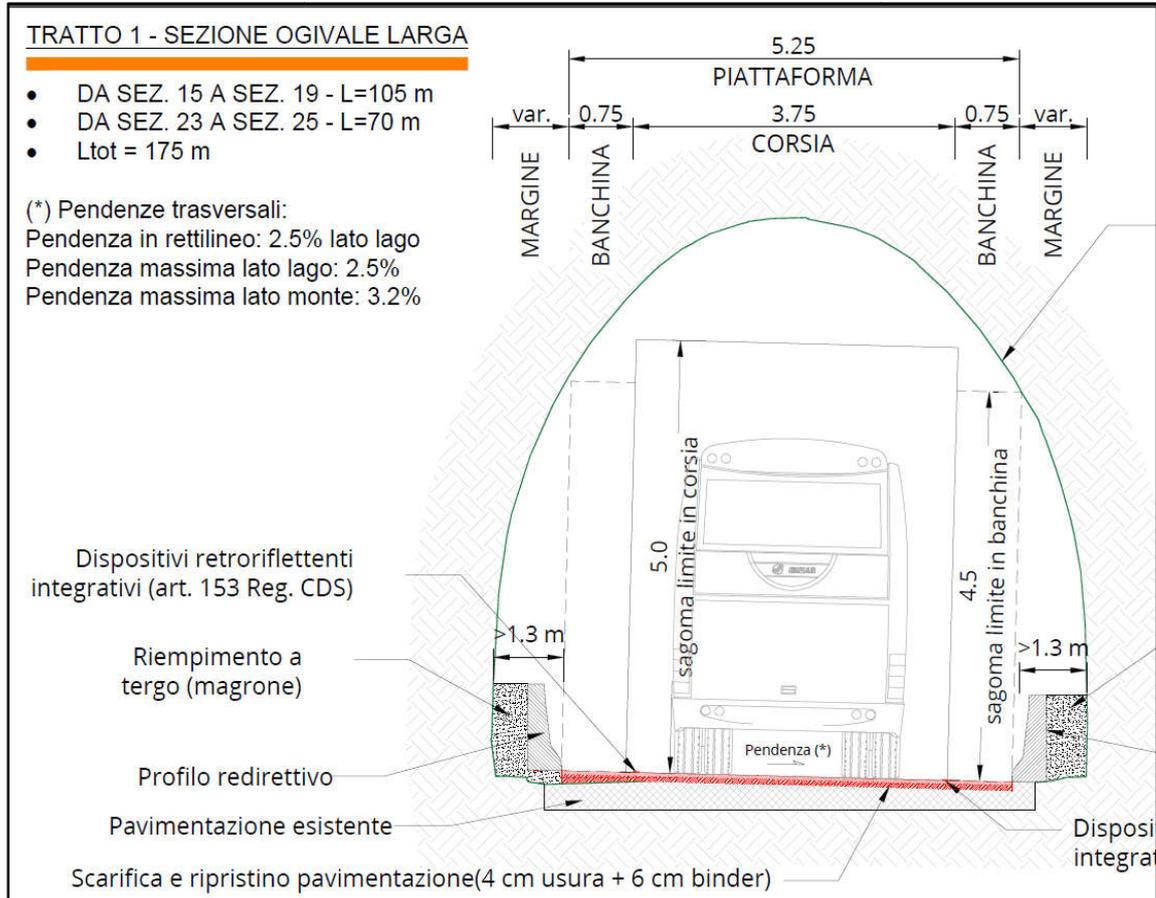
Sezione tipo adeguamento galleria esistenti
